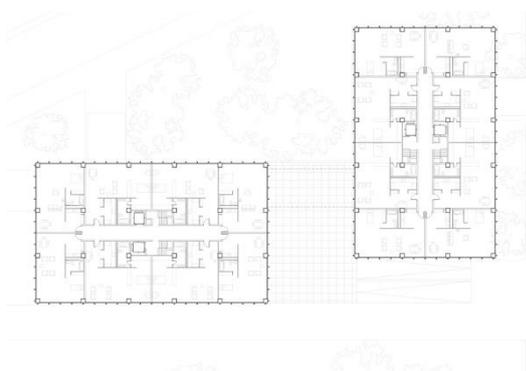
Planta piso habitacional modelo (Krohn, 2011, p. 154).
